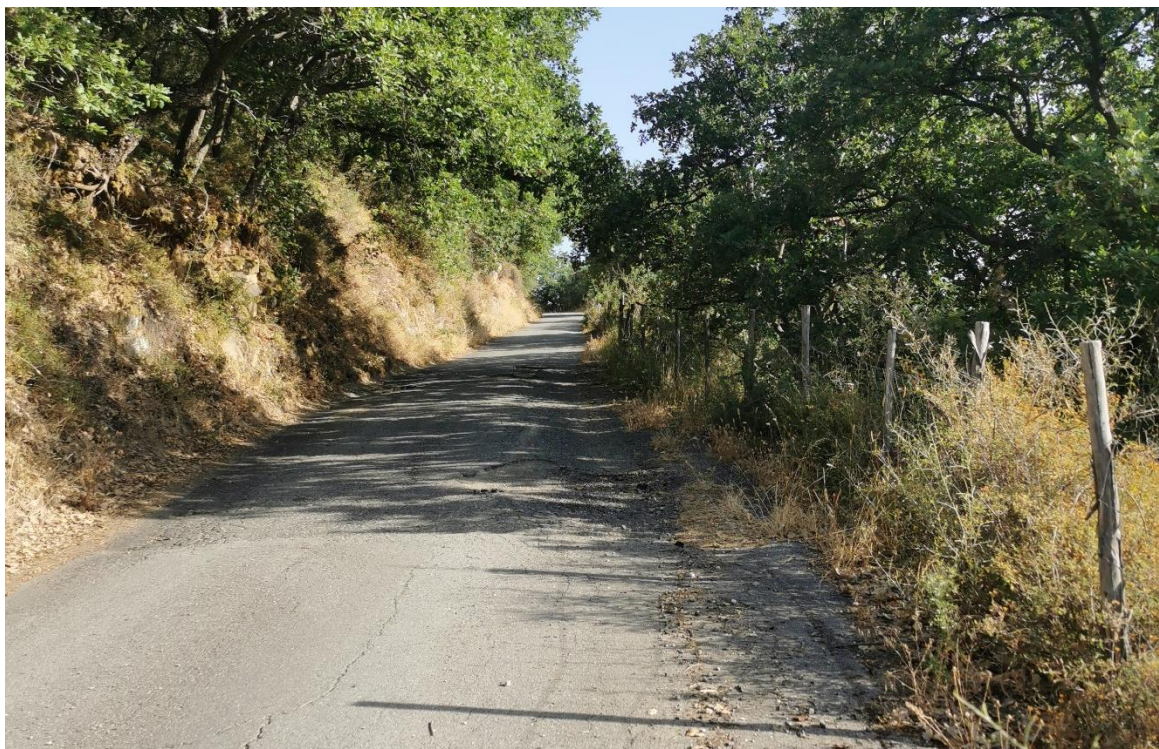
Punto di vista PV14: vista sulla strada dove è prevista la realizzazione del cavidotto MT 30 kV di impianto (coordinate 499946.00 m E 4215277.00 m N)
